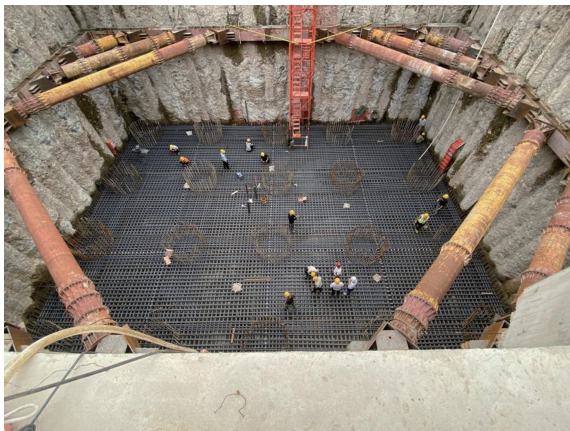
钢筋混凝土咬合桩支护结构内进行施工效果
